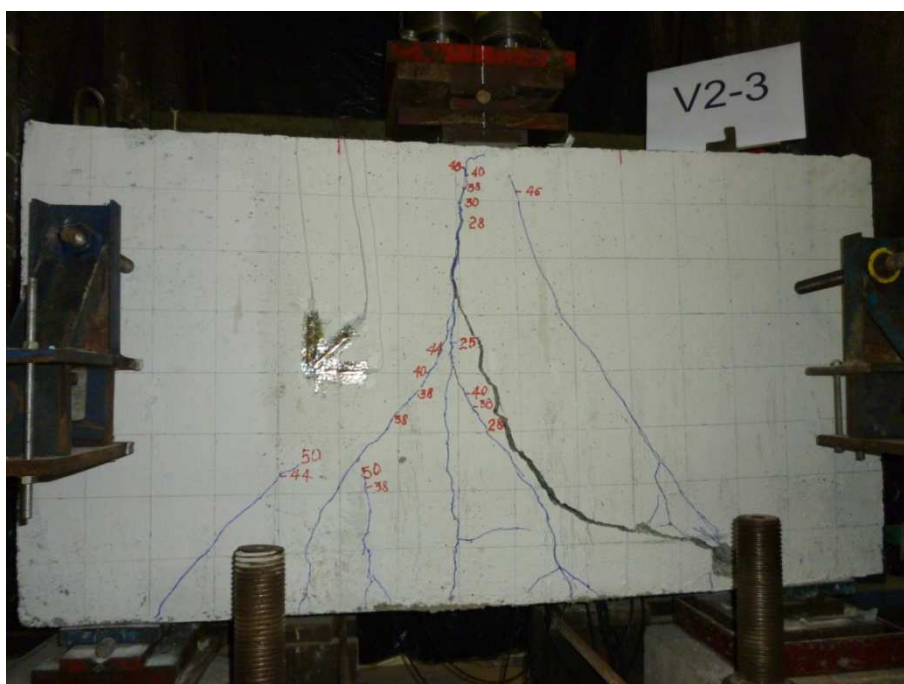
Configuração de fissuras - Viga V2-3.
